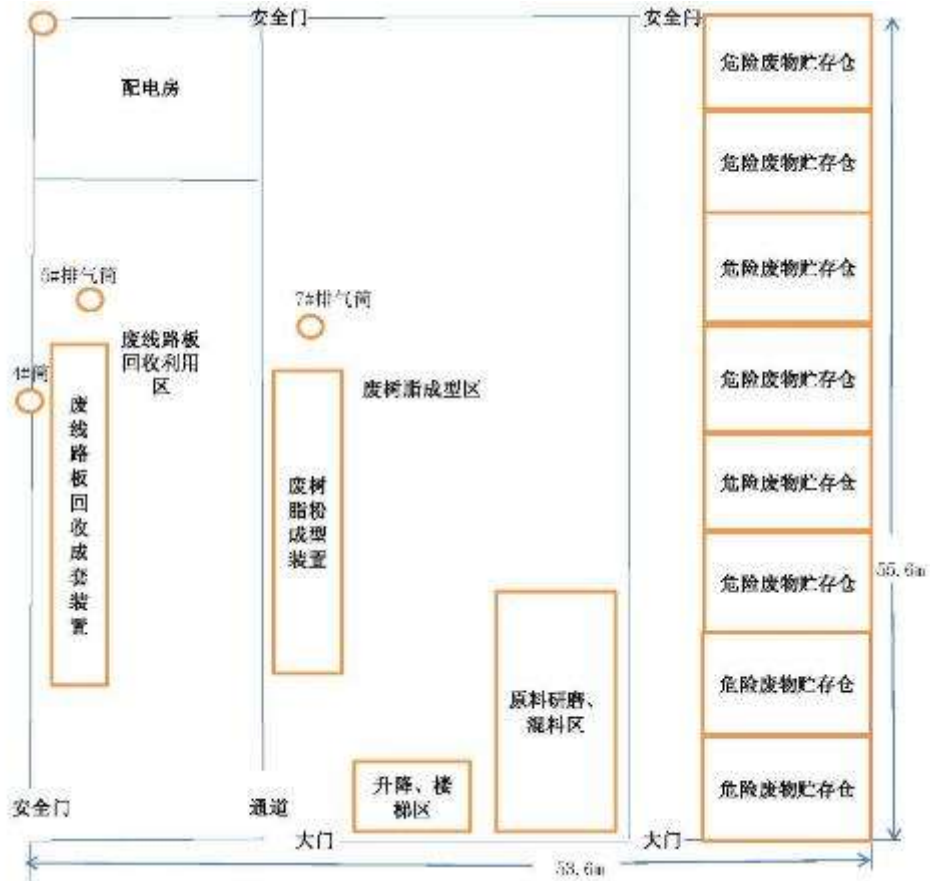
搬迁及改扩建后北厂区 1# 厂房一层平面布置图
